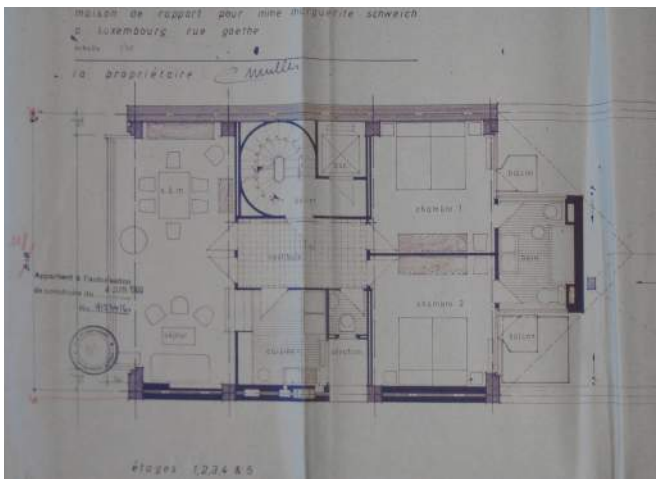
Grundriss, Regelgeschoß (1960)
